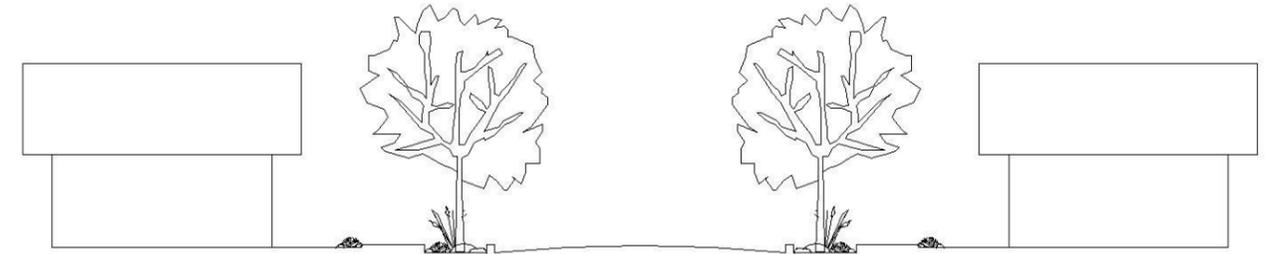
Vías de circulación. Fuente: equipo de trabajo.
